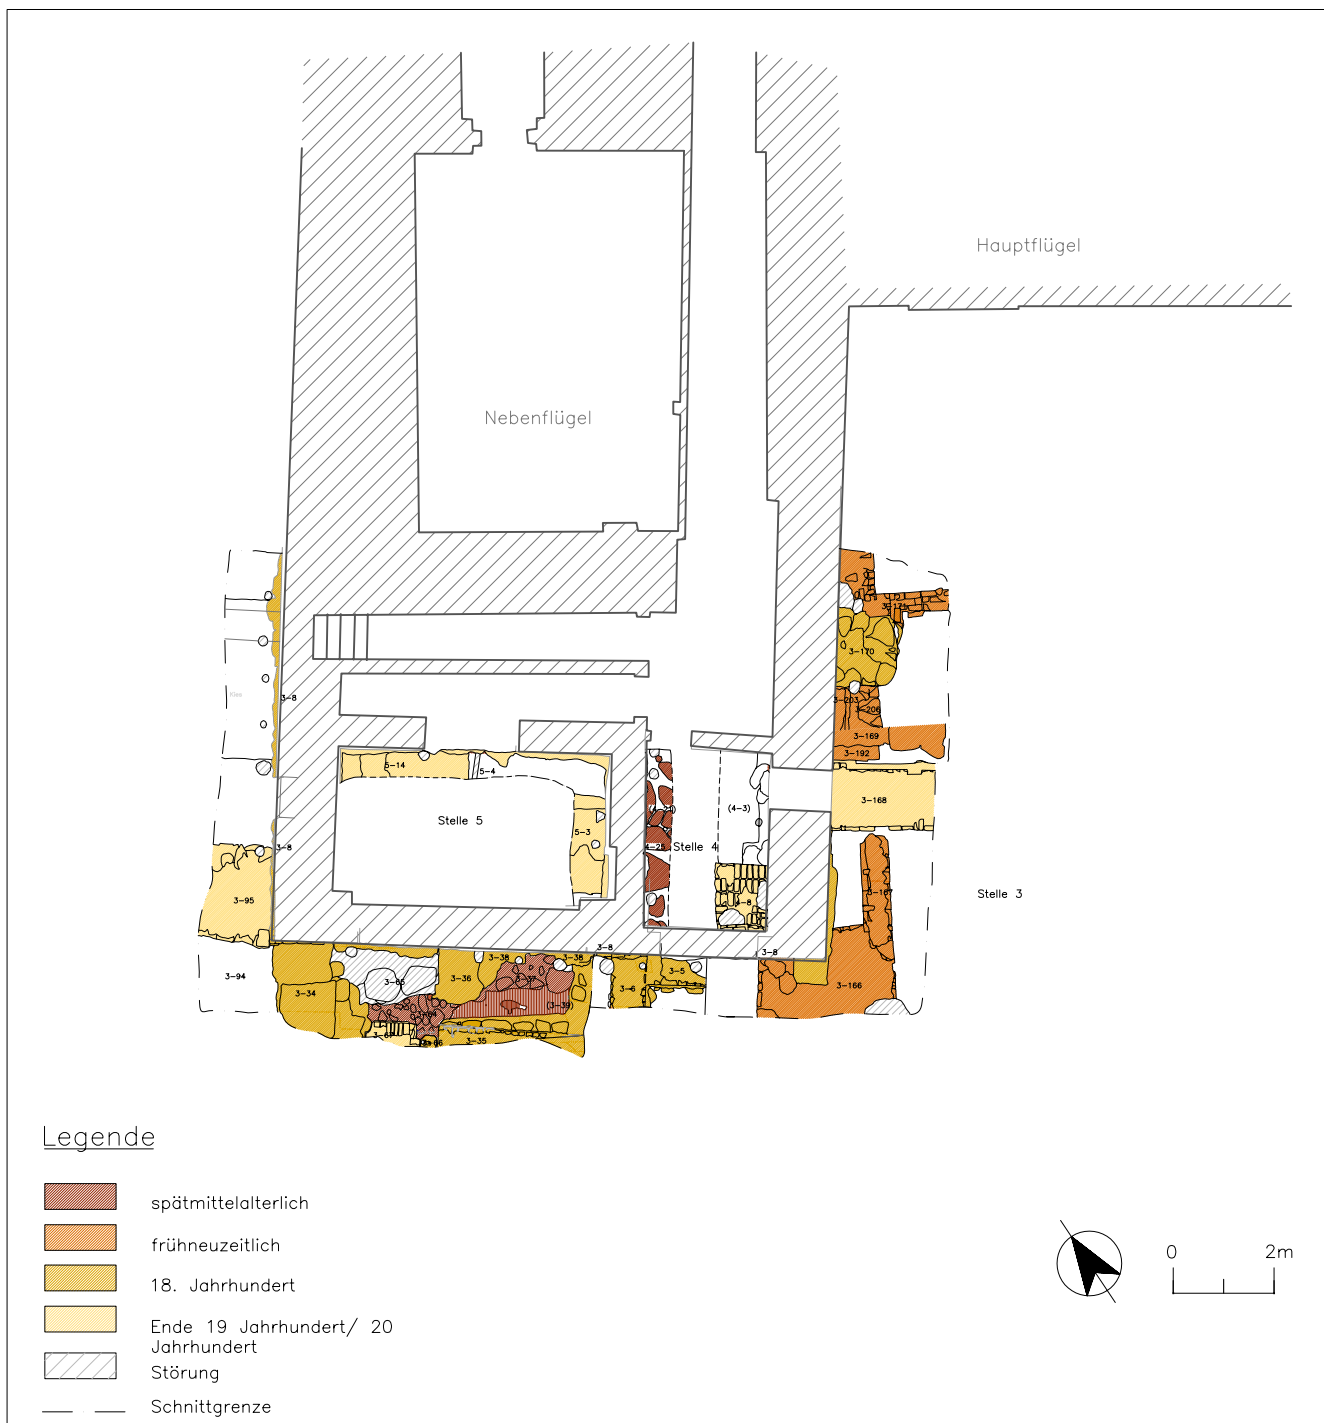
Zichow, Schloss (Kat.-Nr. 224), Grundriss der Westflügels mit älteren Baustrukturen in Sondagegräben (April 2004).
